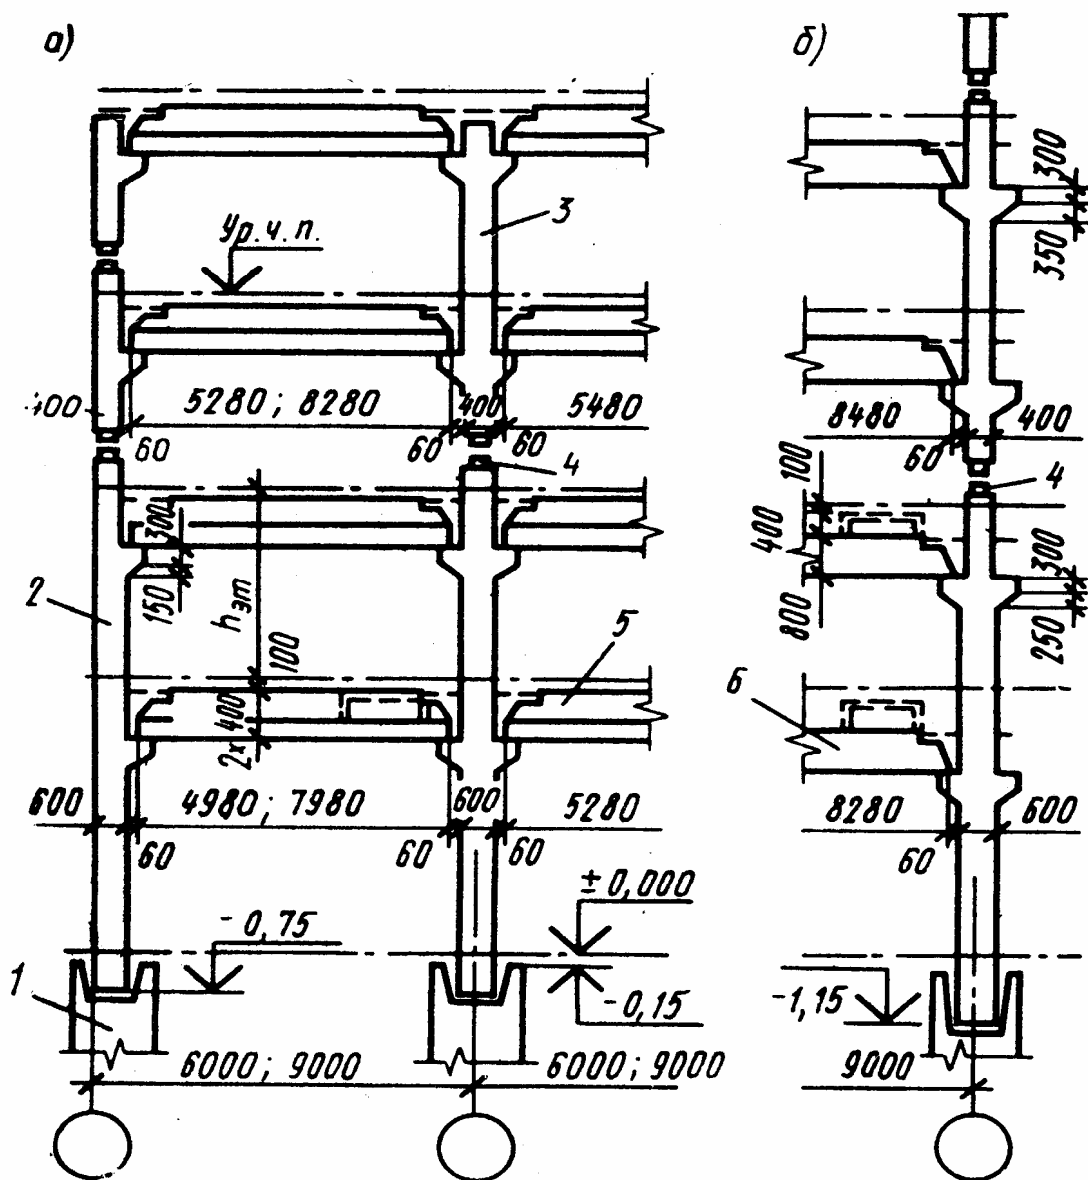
Каркас многоэтажного производственного здания при ригелях с полками (а) и прямоугольных (б)
